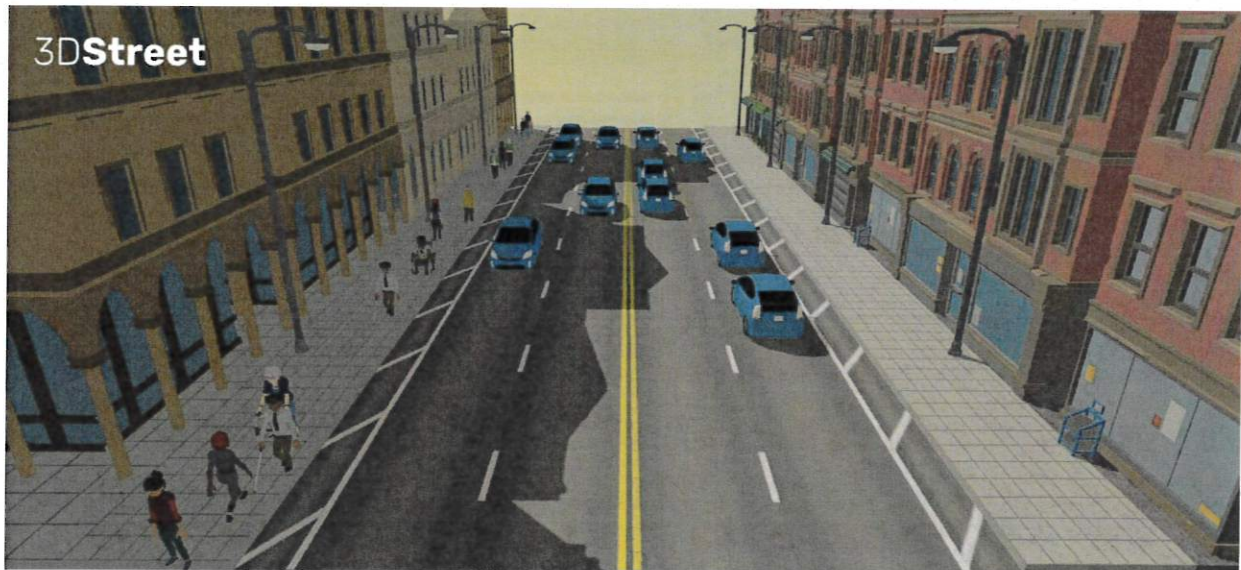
Vedere 3D profil transversal str. Avram Iancu - situația existentă
